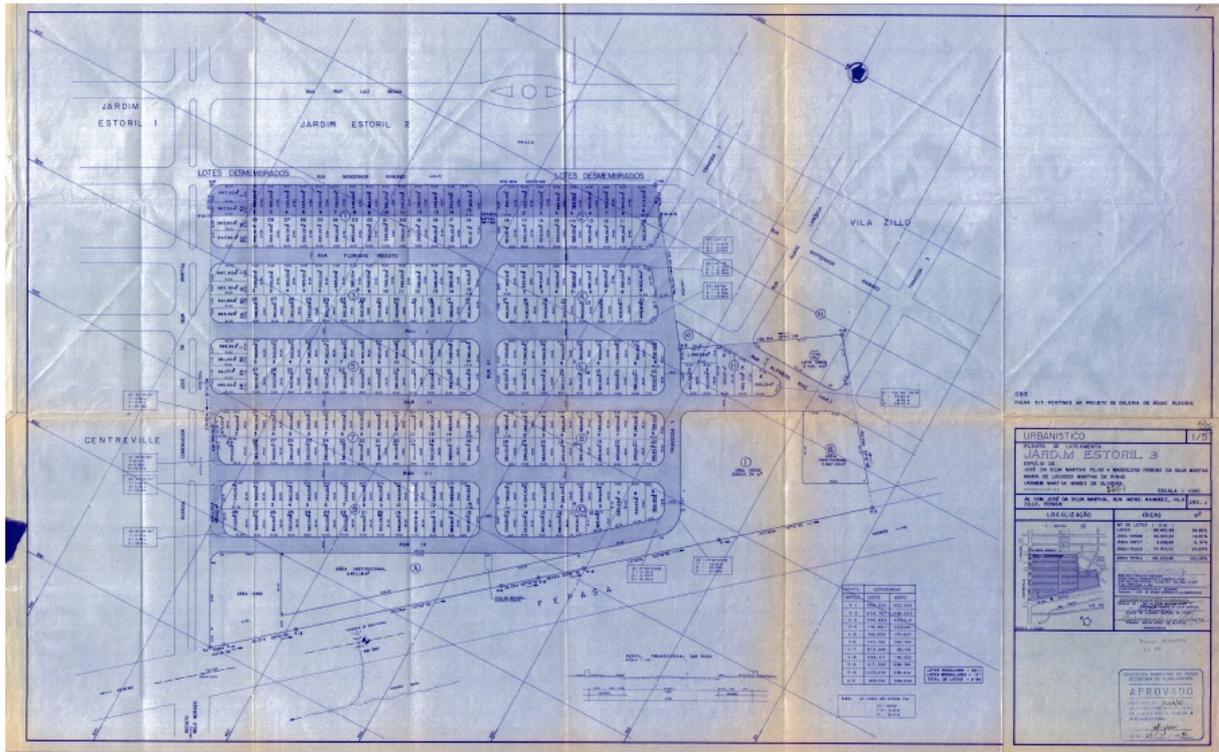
Planta de loteamento Residencial Jardim Estoril 3, aprovada em 1995.
